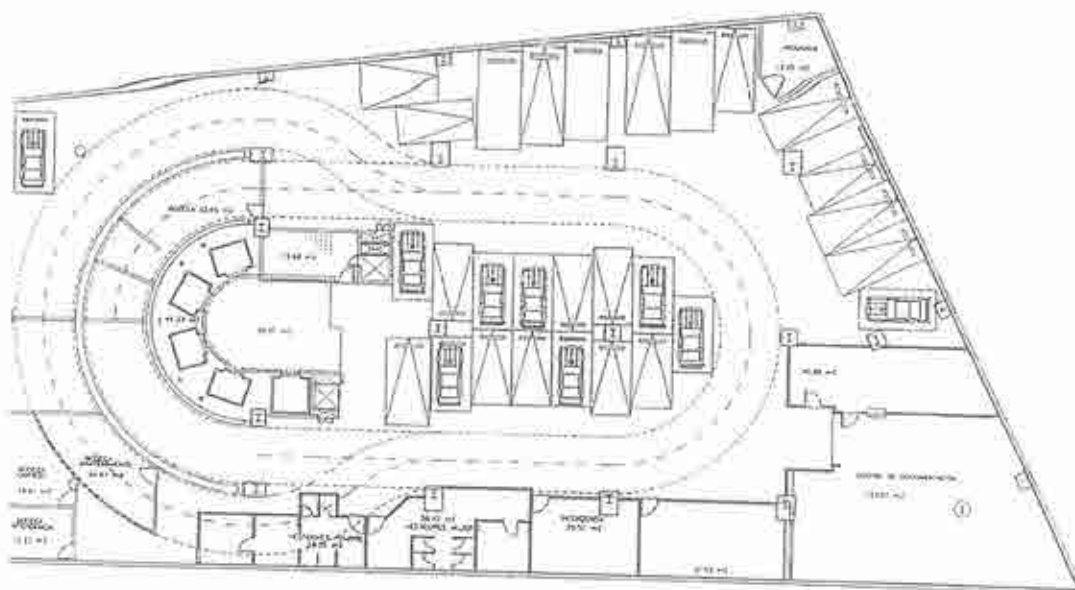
Planta arquitectónica de estacionamiento subterráneo tipo.
